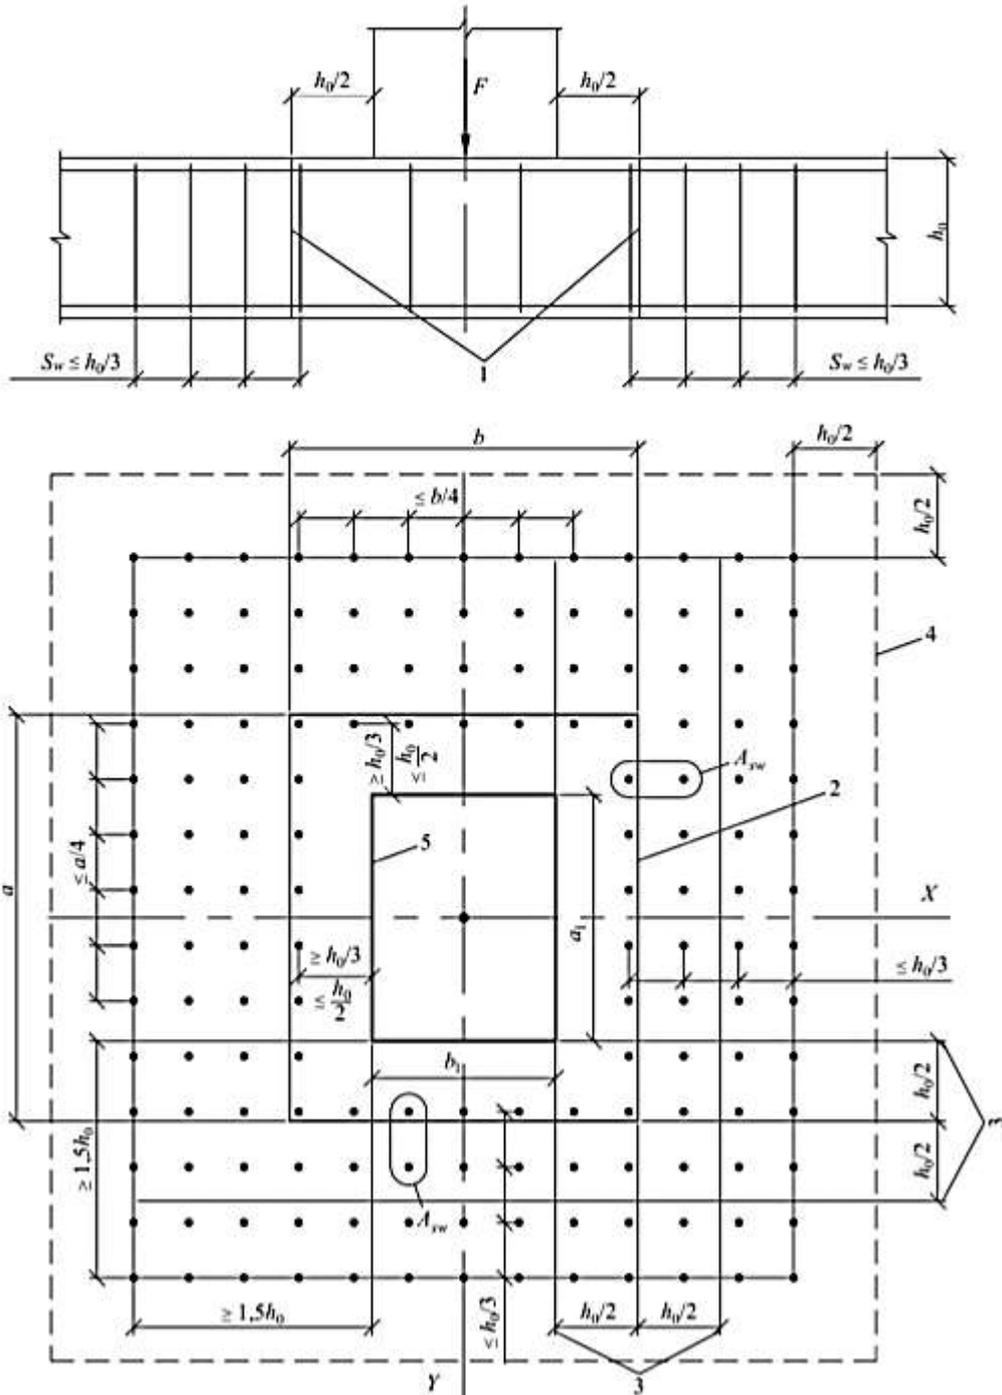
Схема для расчета железобетонной плиты с вертикальной равномерно распределенной поперечной арматурой на продавливание.
